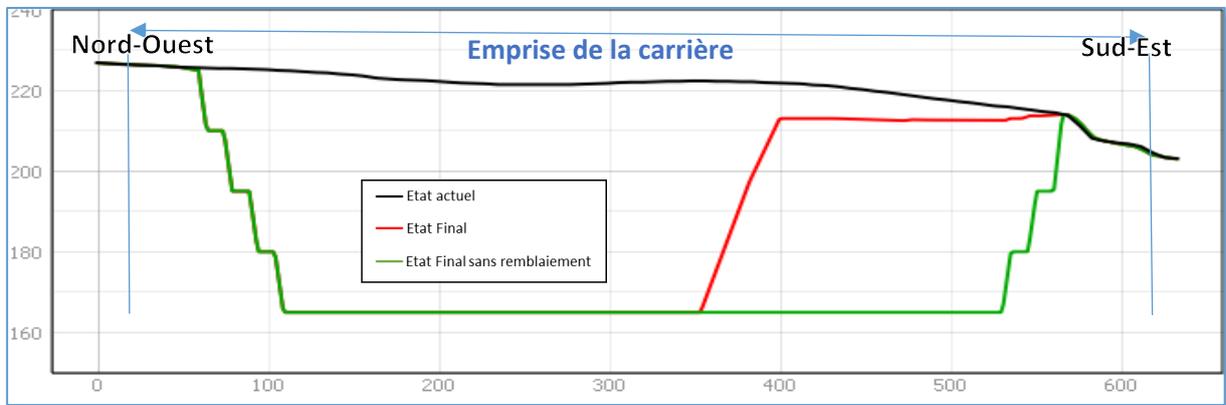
Coupe B selon un profil Nord-Ouest / Sud-Est
